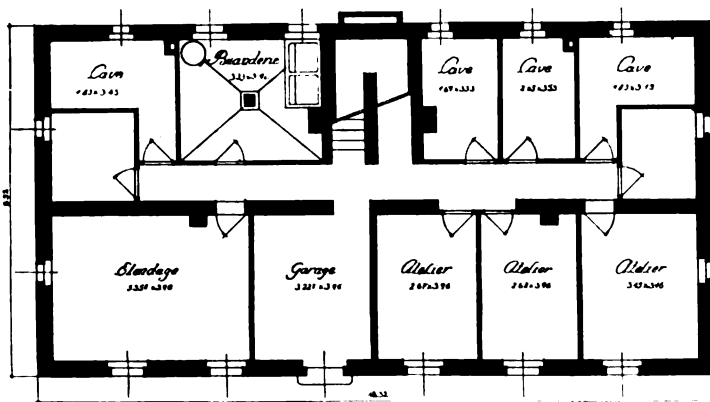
Kellergrundriss 1 : 200. — Wohnhaus für sechs Familien, Typ C. — Abb. 8. Wohngeschoss 1 : 200.
